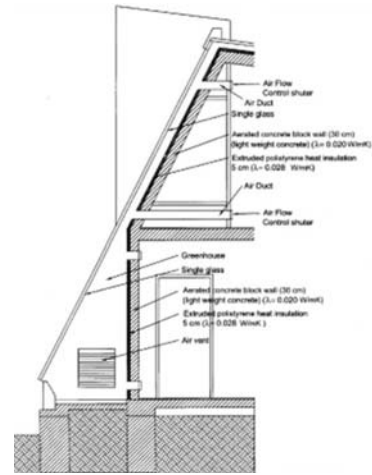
BedZED Hackbridge, Londra. Mimar Bill Dunster 2002.
